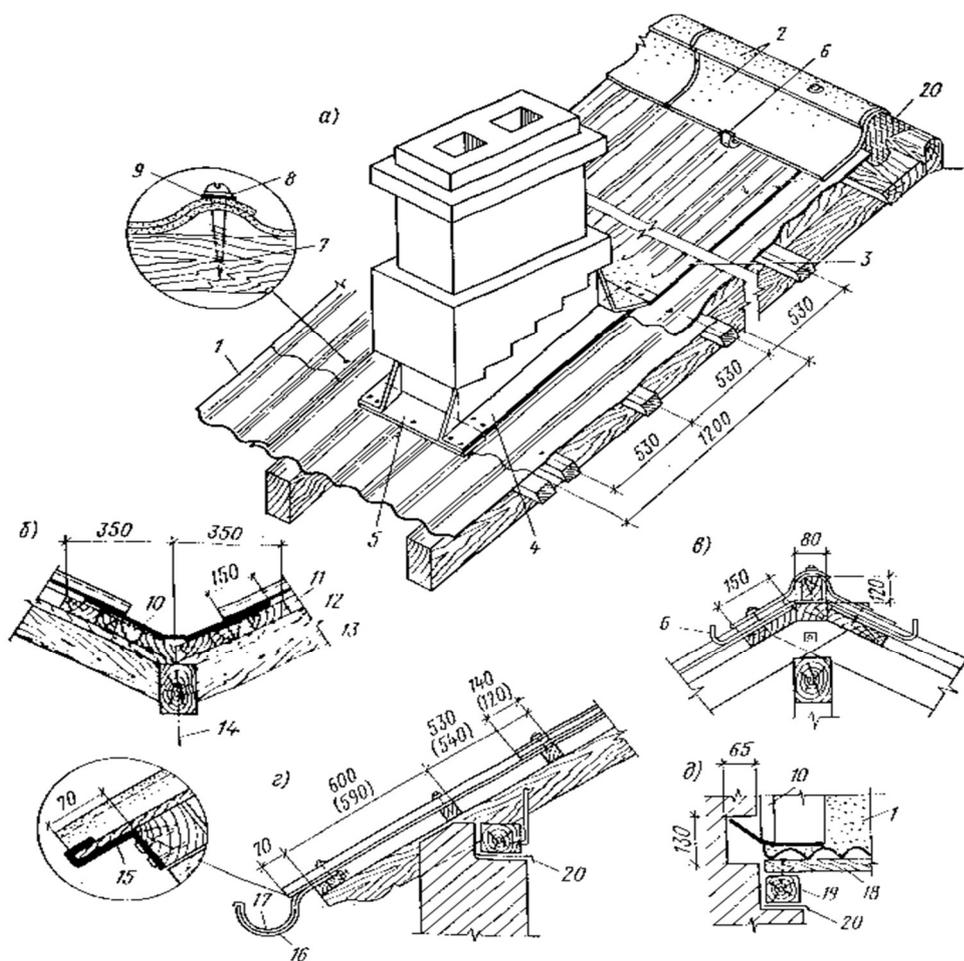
Кровля из волнистых асбестоцементных листов:
